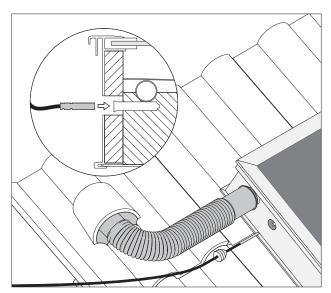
Gummistopfen über Kollektorfühler schieben und Fühlerspitze in Fühlerhülse stecken. Gummistopfen wieder einsetzen.
